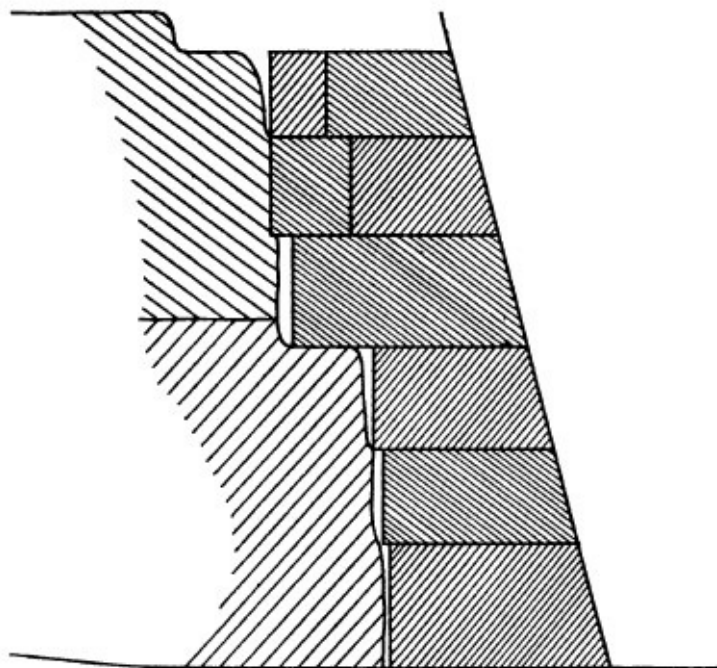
Разрез участка основной стены и облицовки южного фасада мастабы в Гизе
